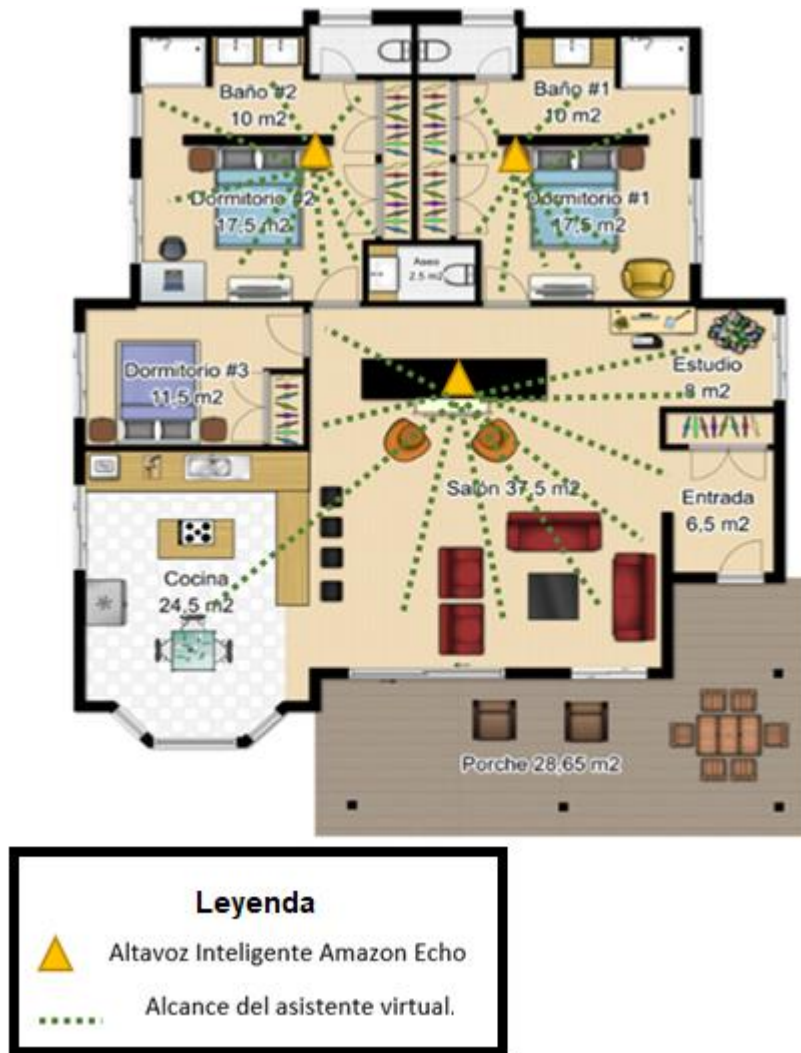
Plano piso piloto con altavoces inteligentes colocados.
